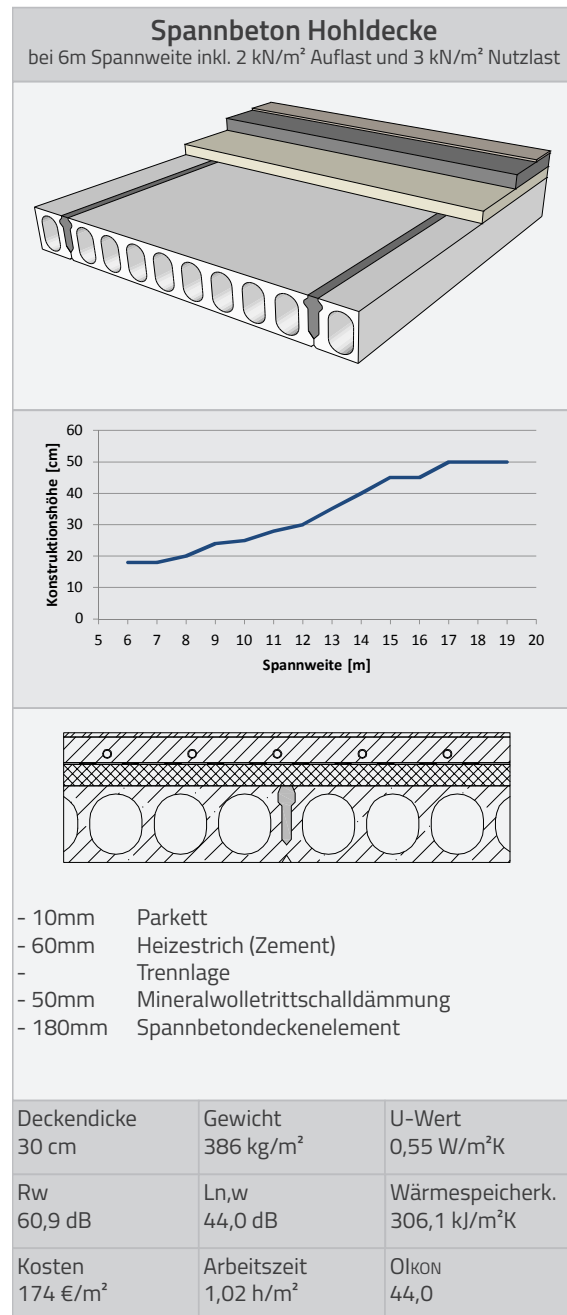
Kompaktübersicht Spannbeton-Hohldecke
